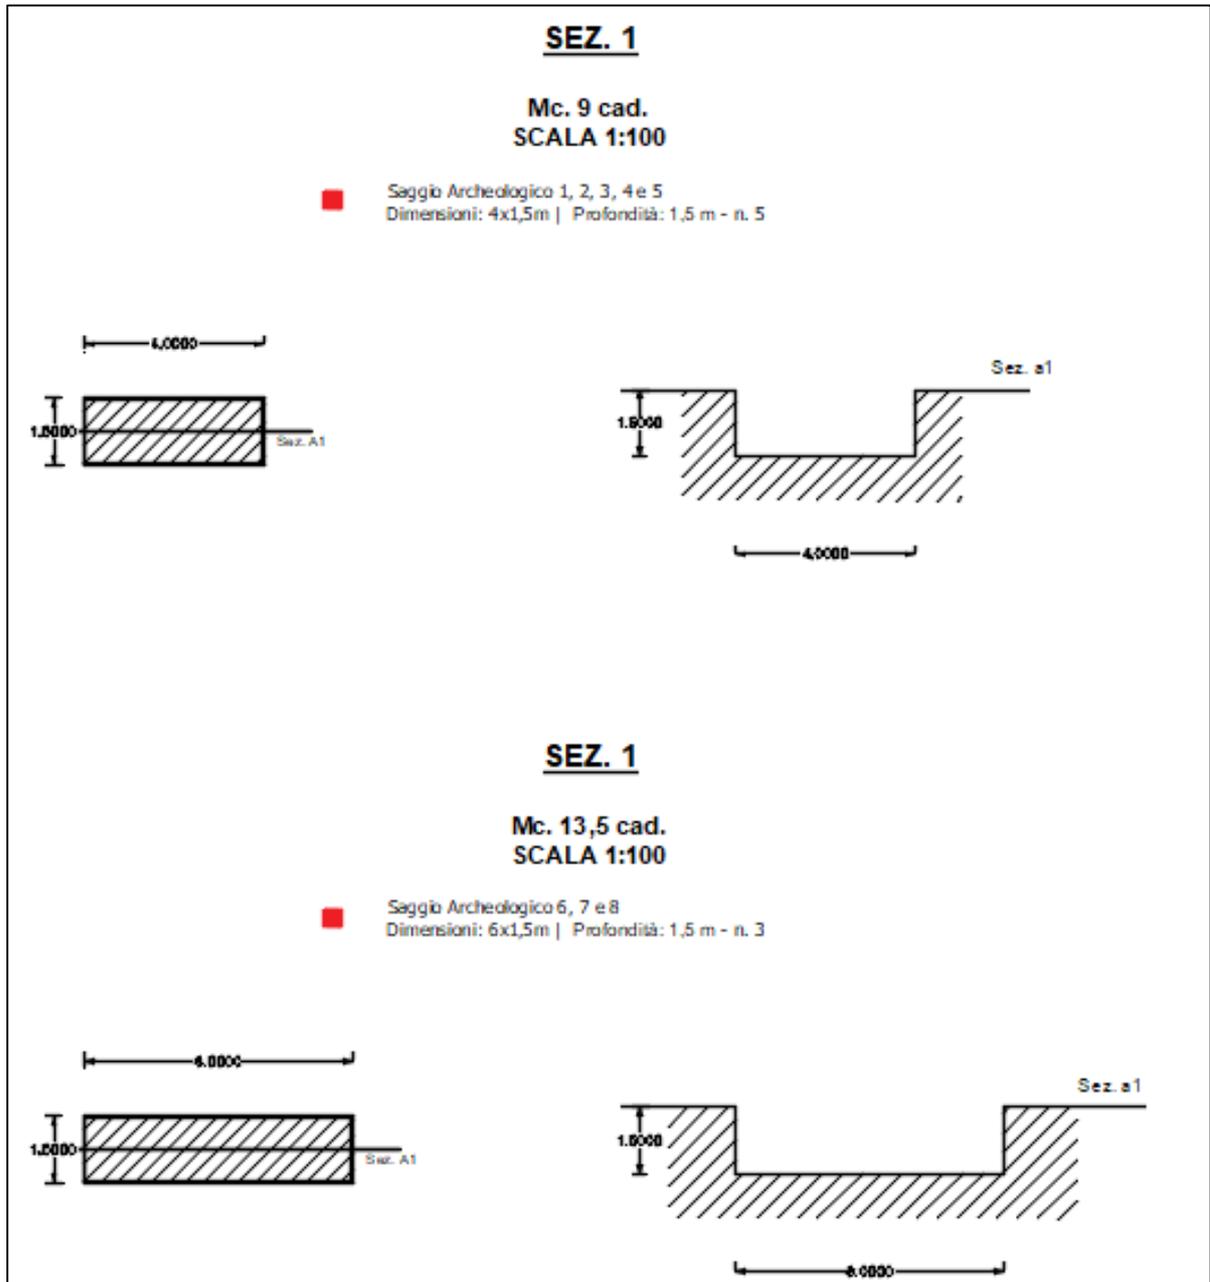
Pianta e sezione del saggio di scavo proposto.
